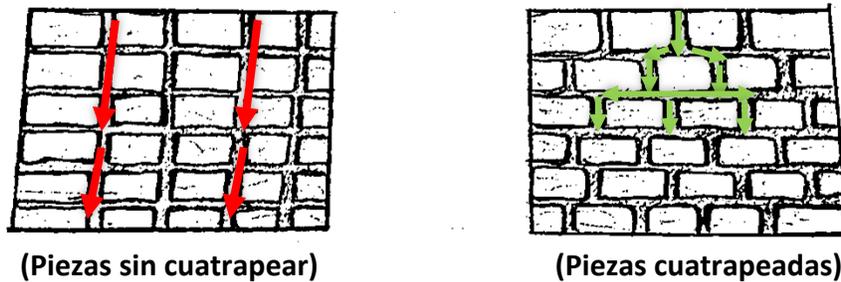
, Tipos de cuatrapeo de las piezas de los muros de mampostería.
